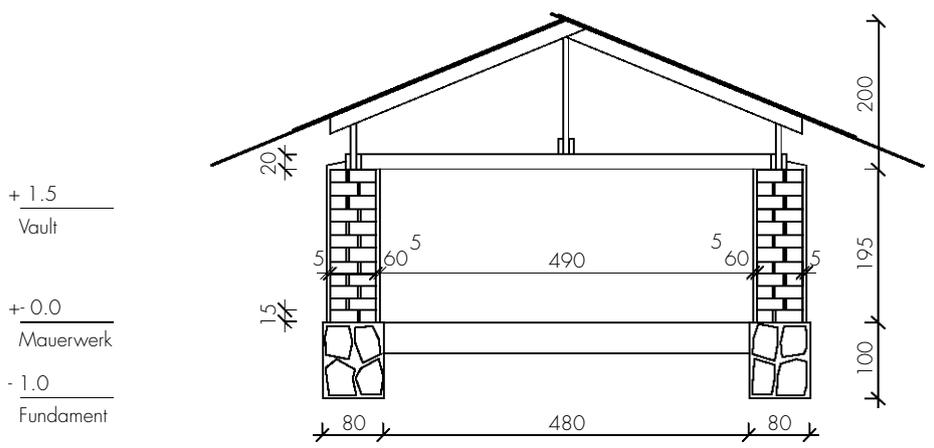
| Rundbau Variante IV, luftgetrocknete Lehmziegel mit Holz-Stroh-Dach
